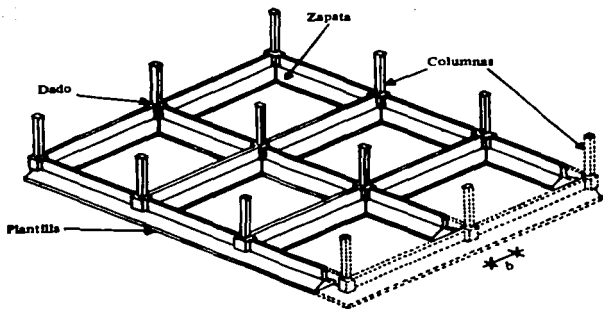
b. Cimentación a base de zapatas corridas en dos direcciones.
